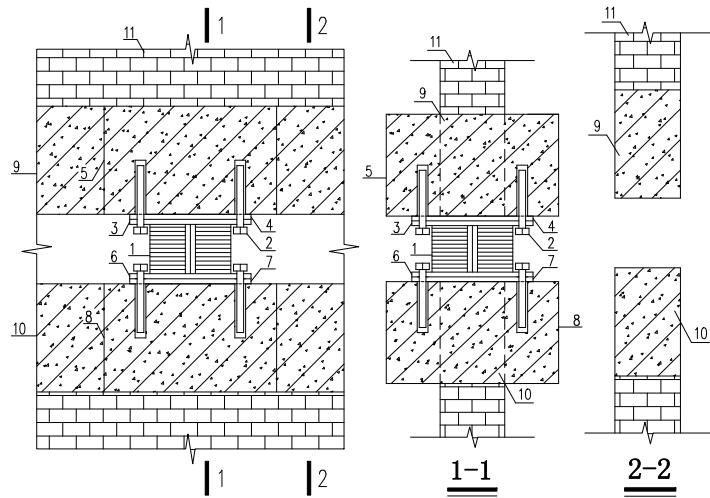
单梁墙体托换及隔震支座安装示意图
